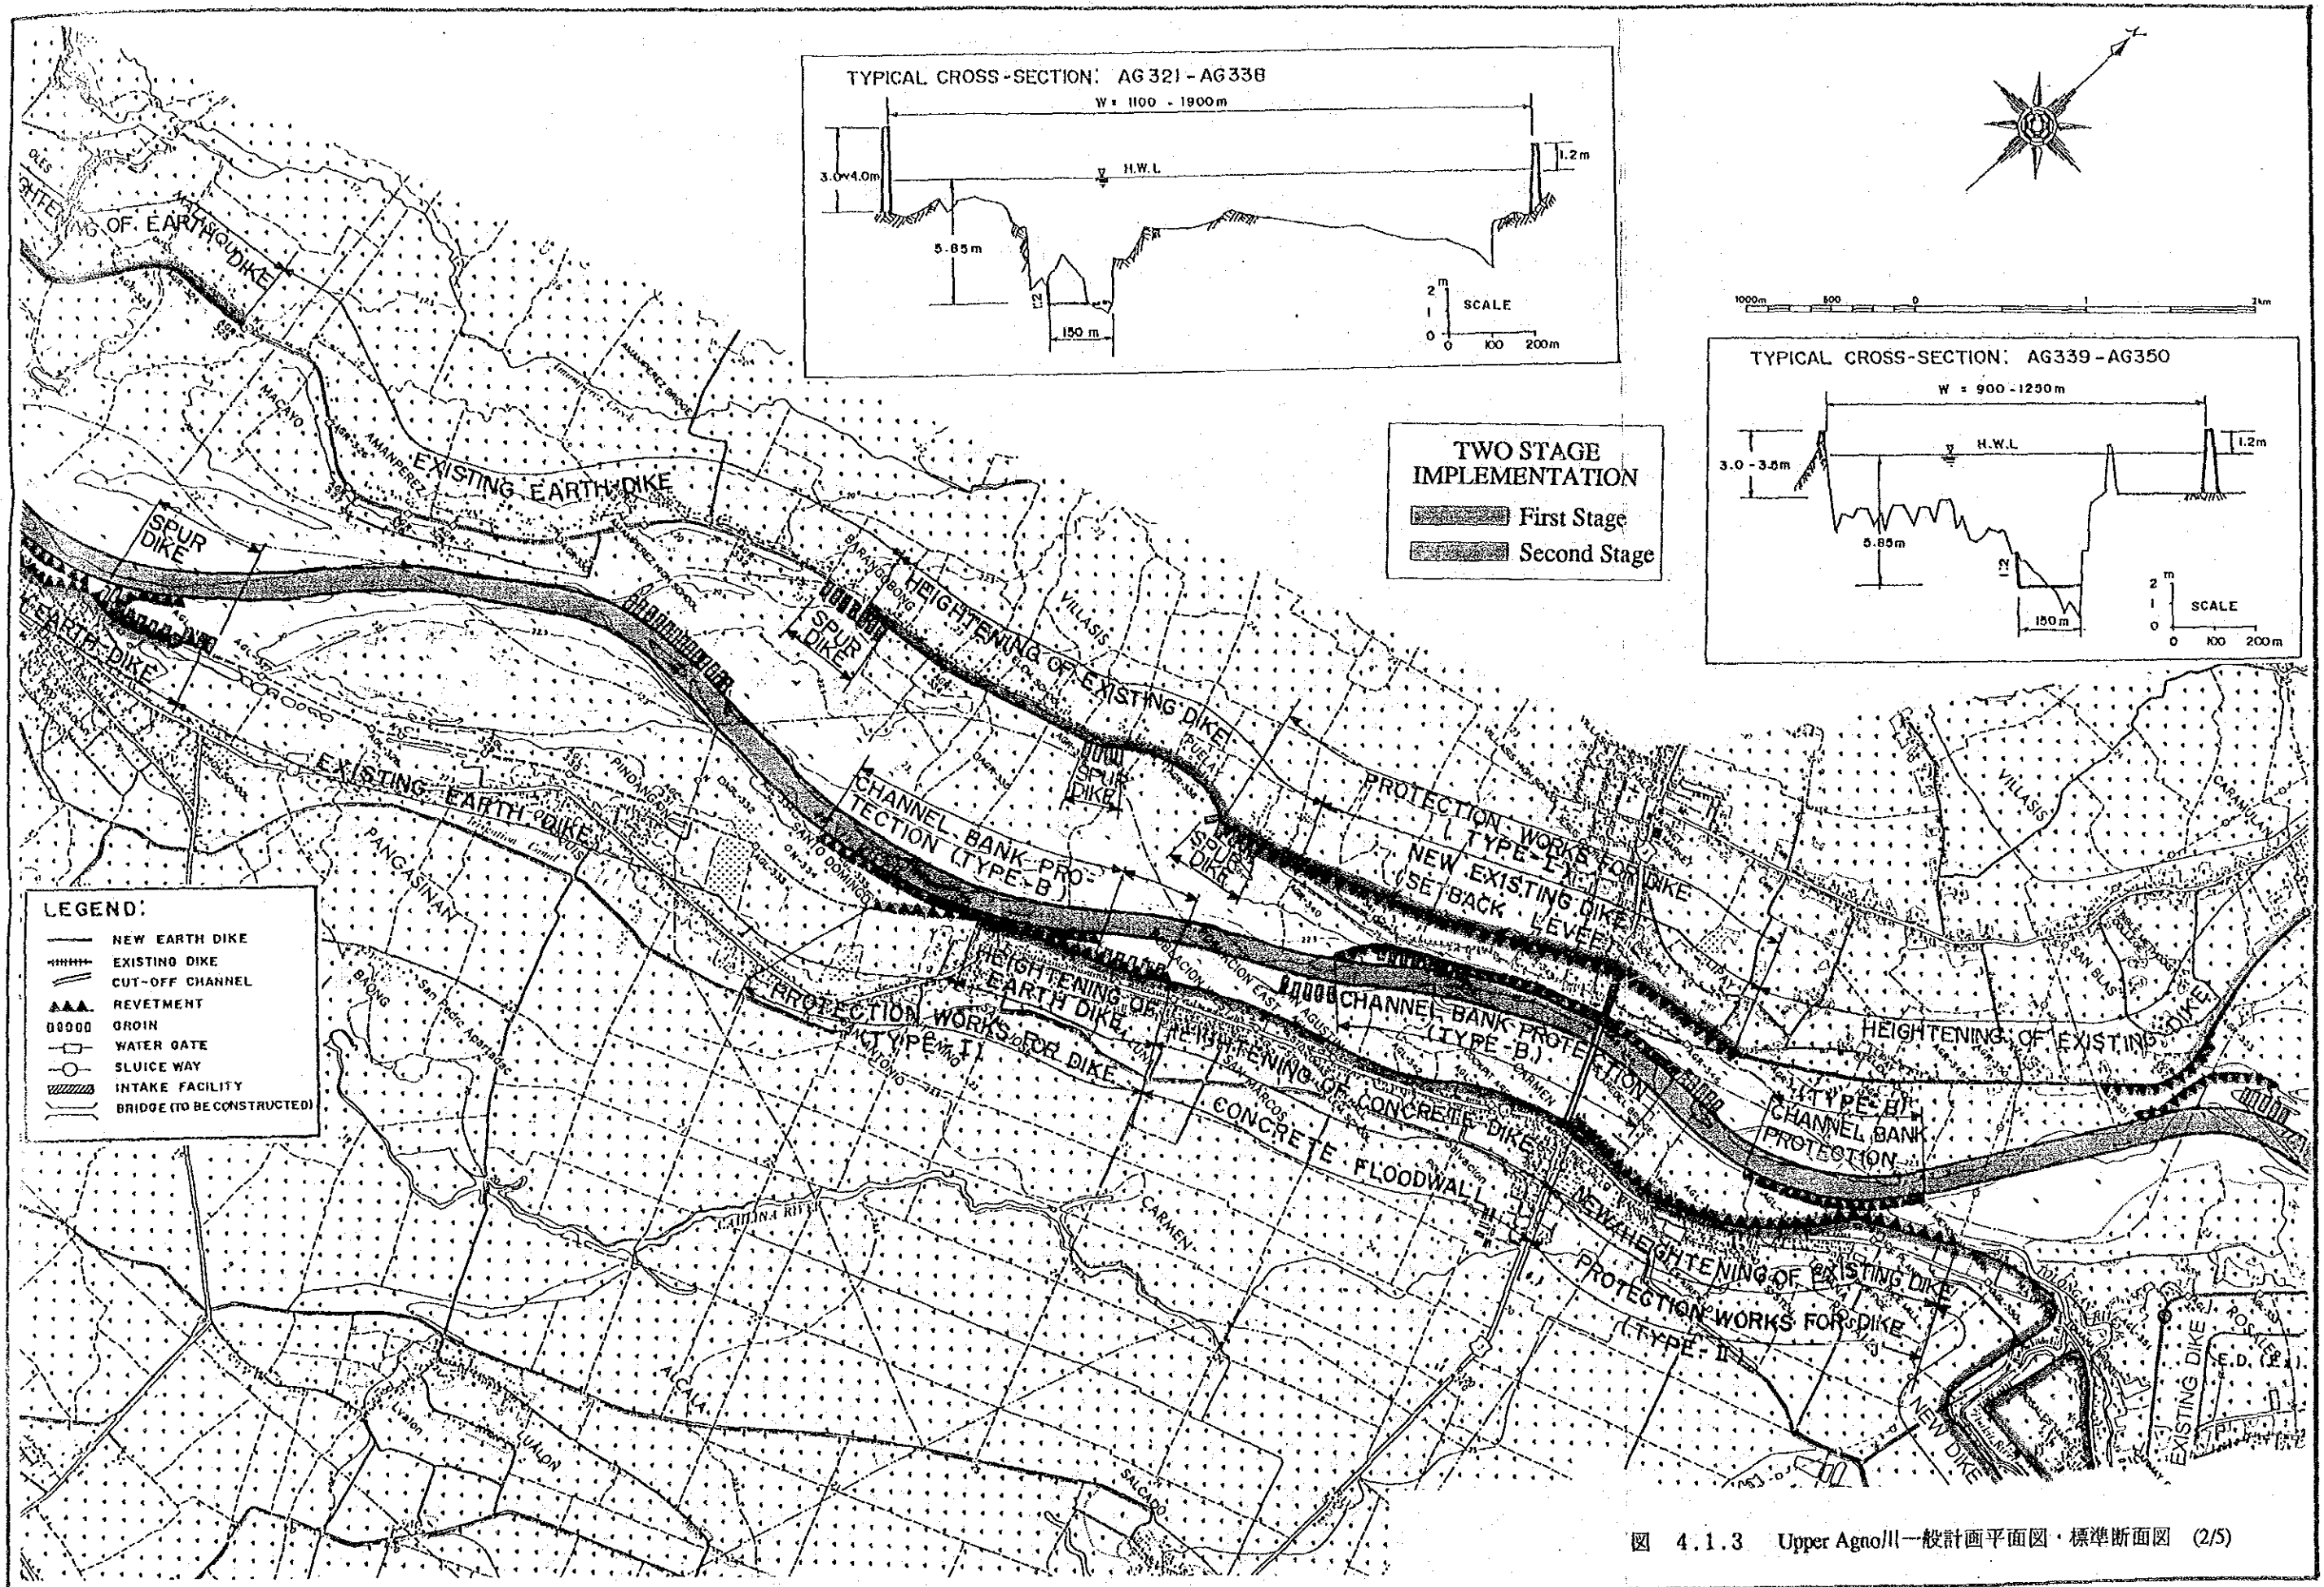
Upper Agno川一般計画平面図・標準断面図 (2/5)
